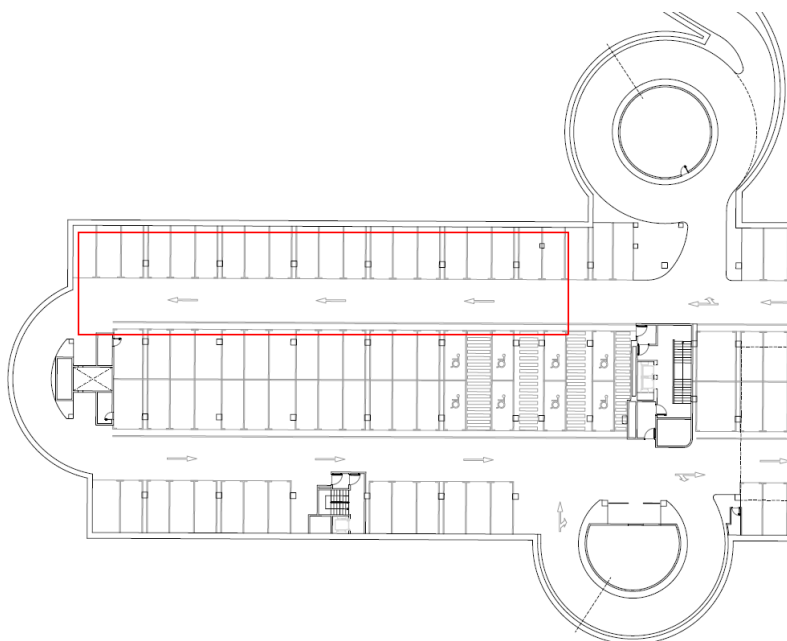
Zona donde se localizan las fisuras de los forjados reticulares
